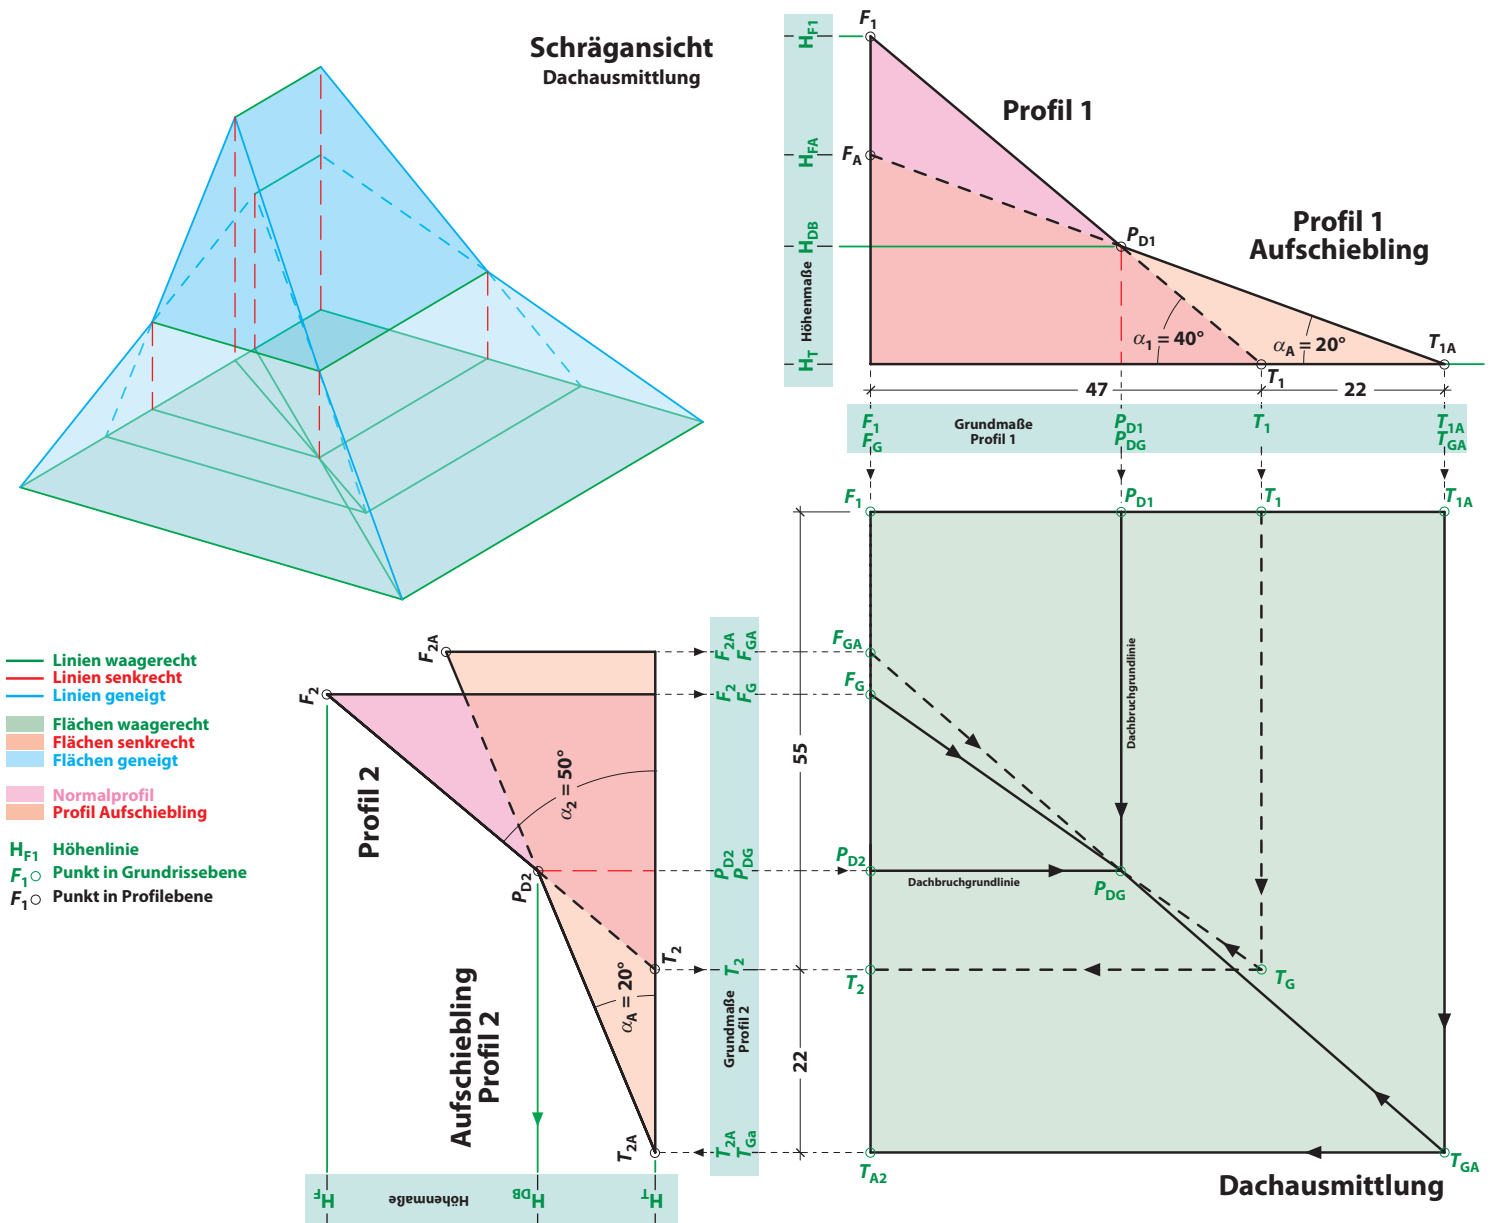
Dachausmittlung – ohne Maßstab – des gesamten Dachkörpers in einer Zeichnung. Es empfiehlt sich, beide Dachkörper nacheinander vollständig auszumitteln. Im Grundriss sind jetzt die beiden Dachausmittlungen aus Bild 13 „übereinander gelegt“. Punkt P_{DG} ist der Anfallspunkt beider Gratgrundlinien am Dachbruch. Die Strecken $F_G - P_{DG}$ und $P_{DG} - T_{GA}$ zeigen sich in den Profilen als die jeweiligen Gratlinien.
